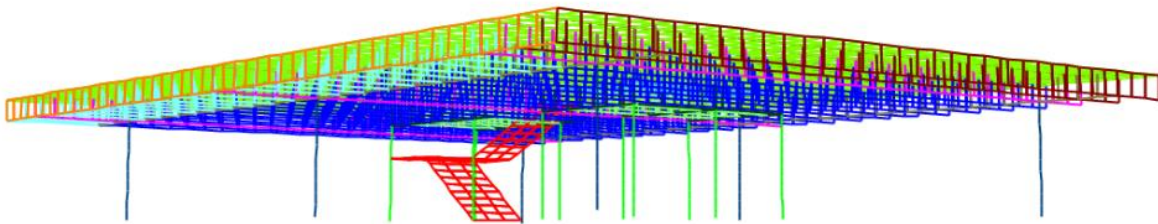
Vista inferior da Laje do 1 Pavimento da Estrutura Sem Mesa Inferior
